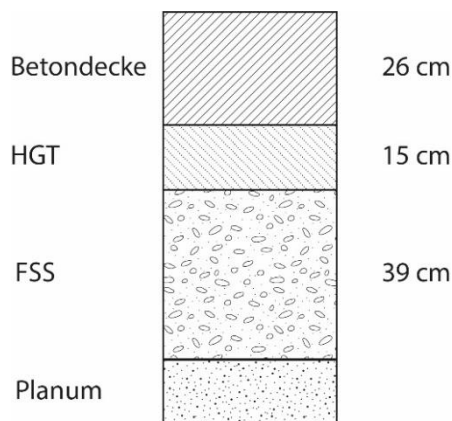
Strecke einer BAB mit 22 Jahren Liegedauer mit Betondecke auf HGT auf FSS
